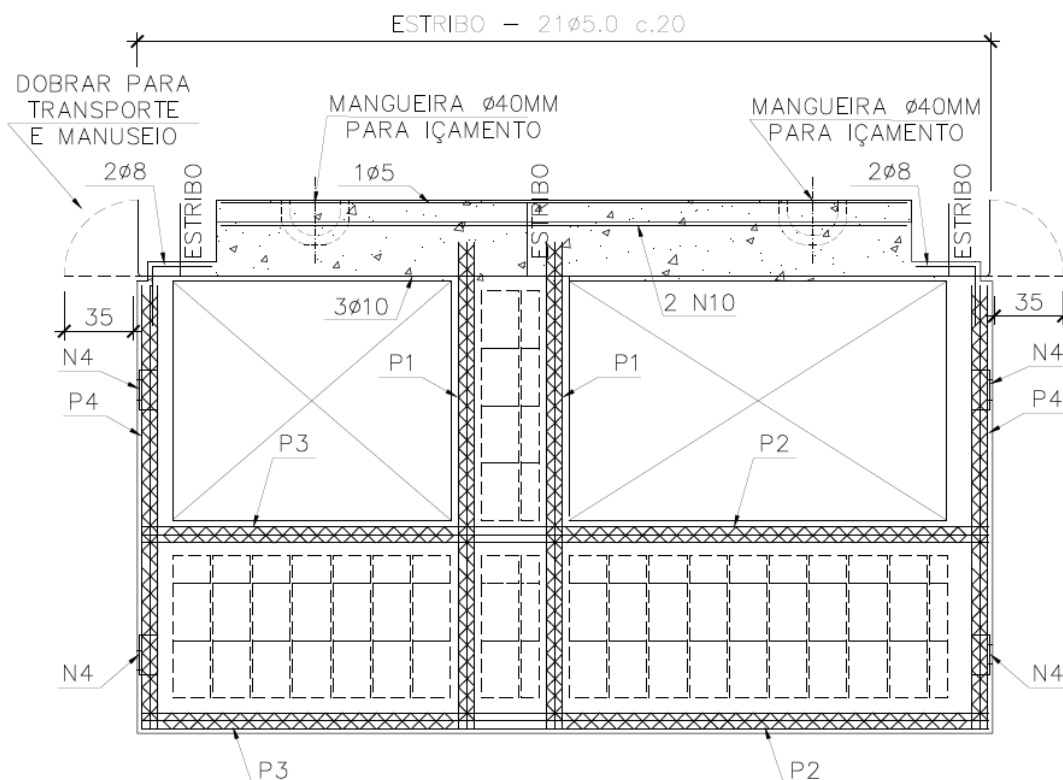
Desenho esquemático do painel de vedação com viga incorporada.
